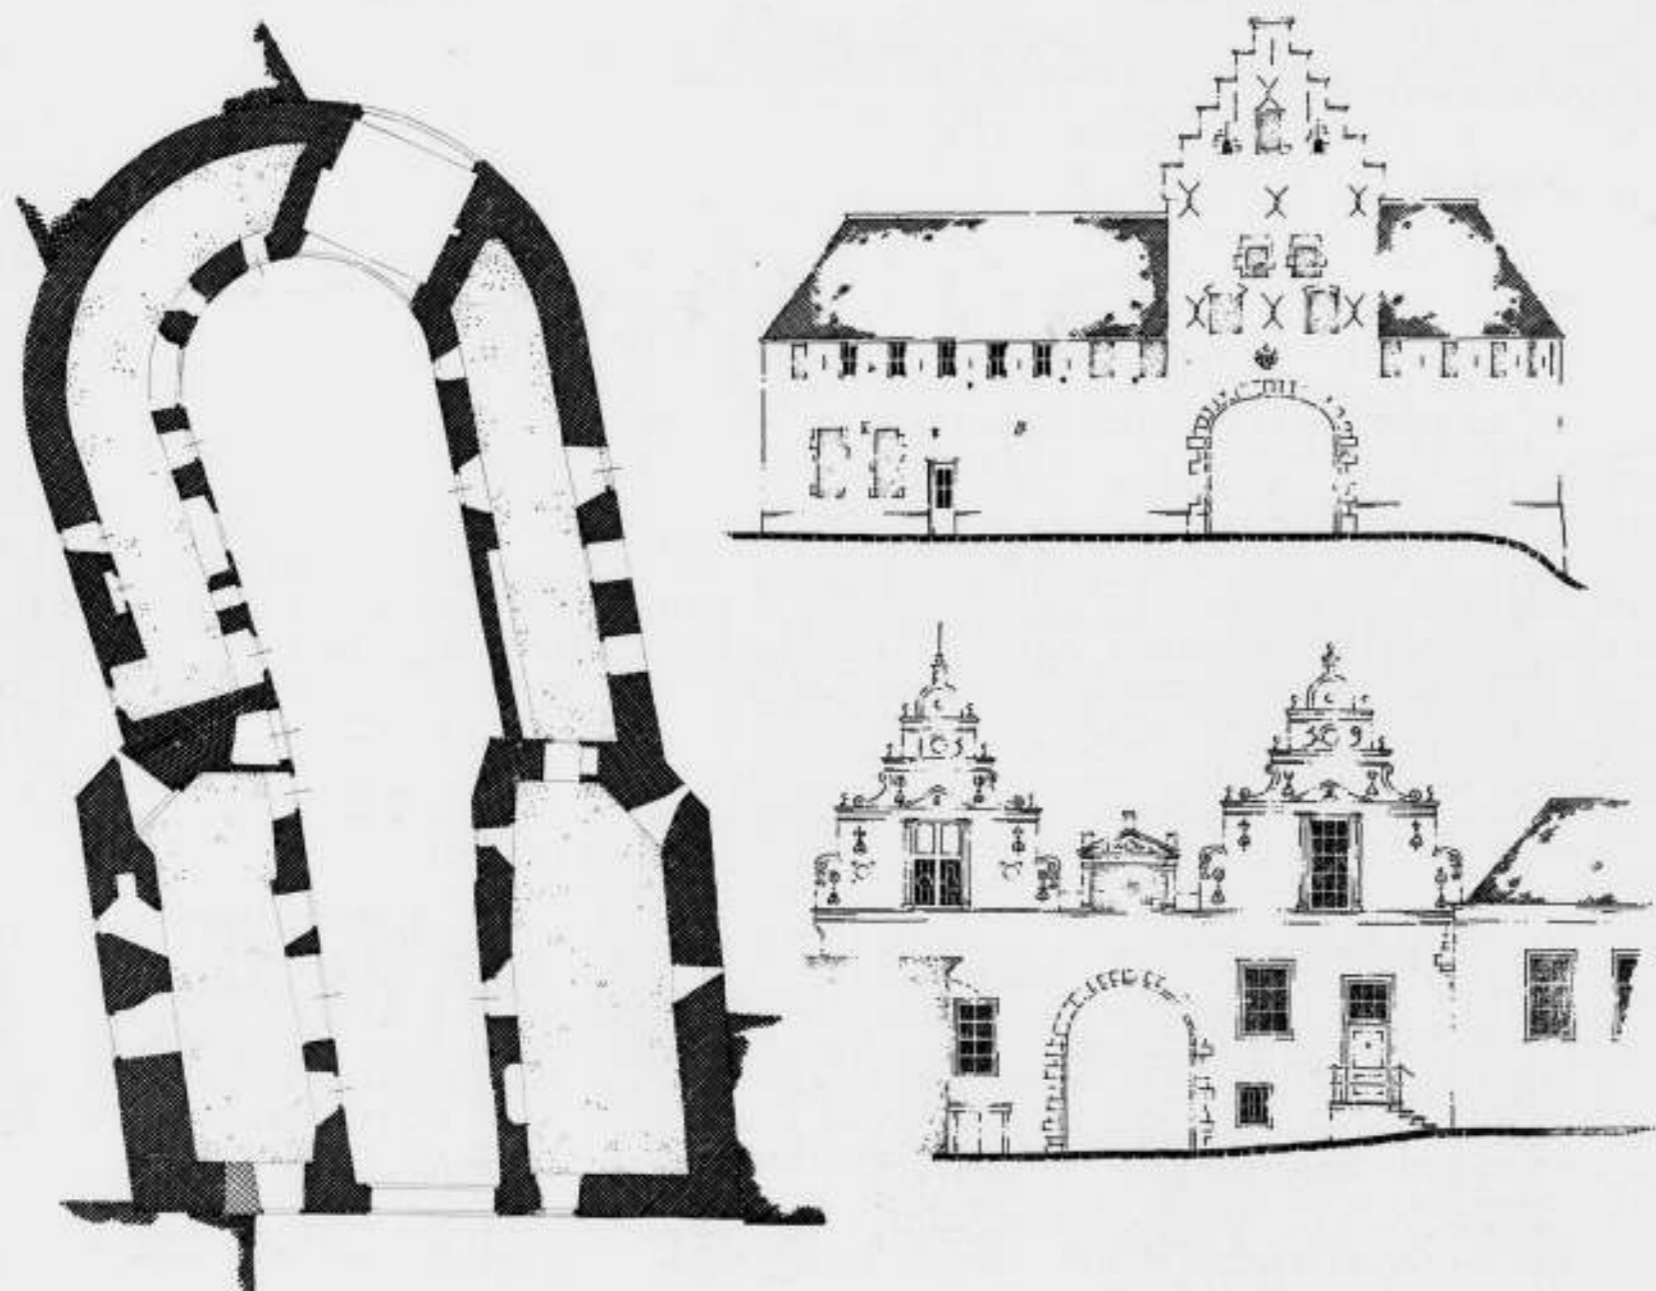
NOORDERHAVENPOORT. PLAN, BUITENGEVEL LANDZIJDE, BUITENGEVEL STADSZIJDE. SCHAAL 1 À 200
